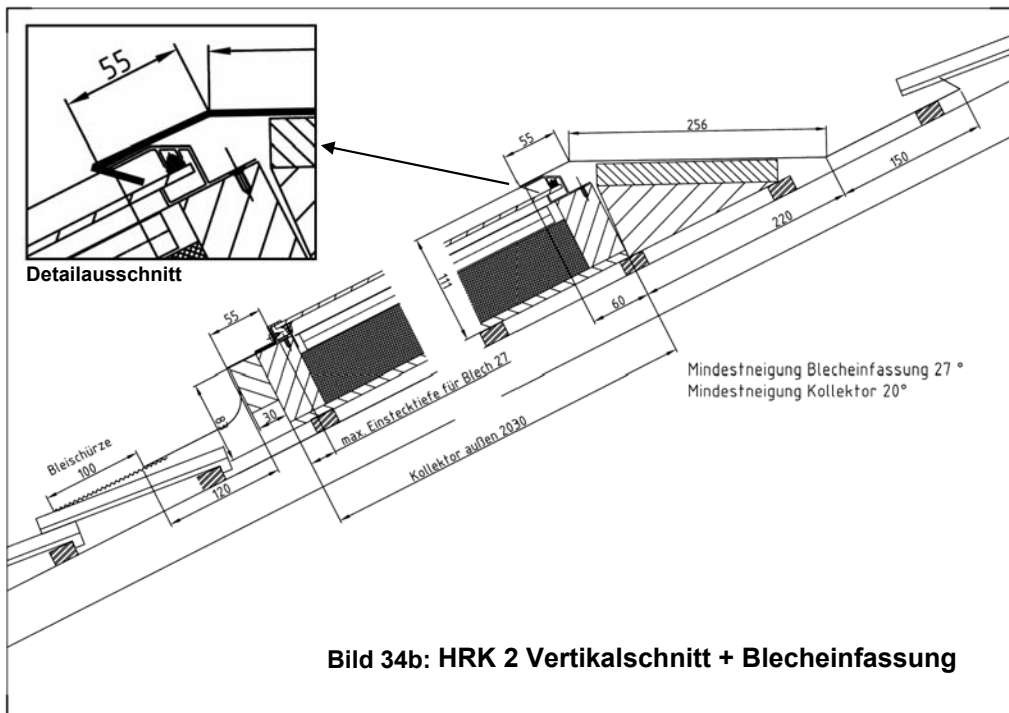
HRK 2 Vertikalschnitt + Blecheinfassung
